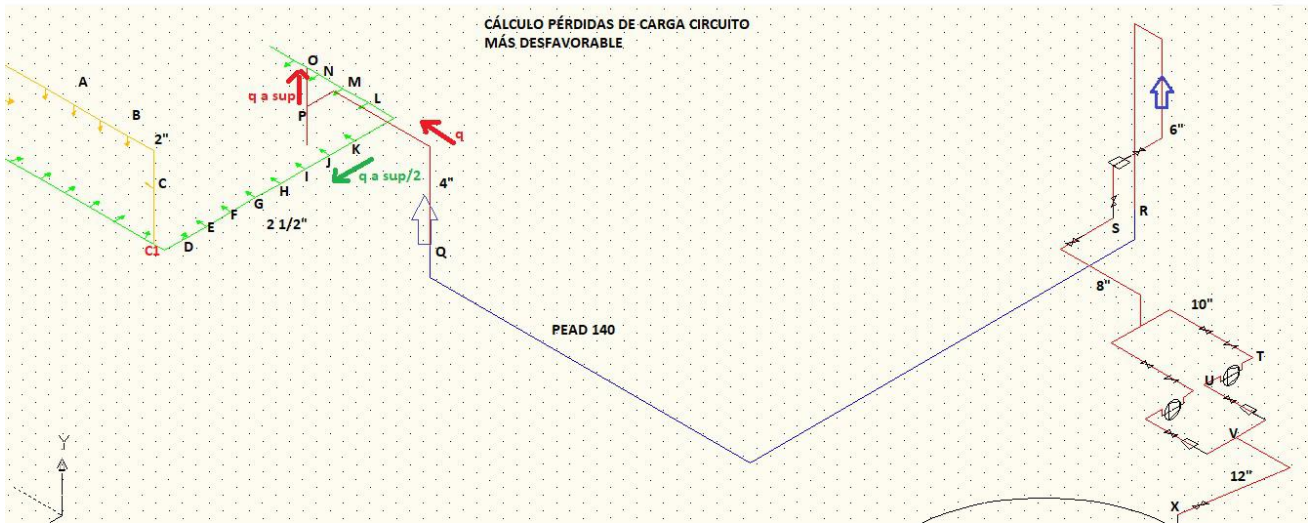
Cálculo pérdidas instalación
